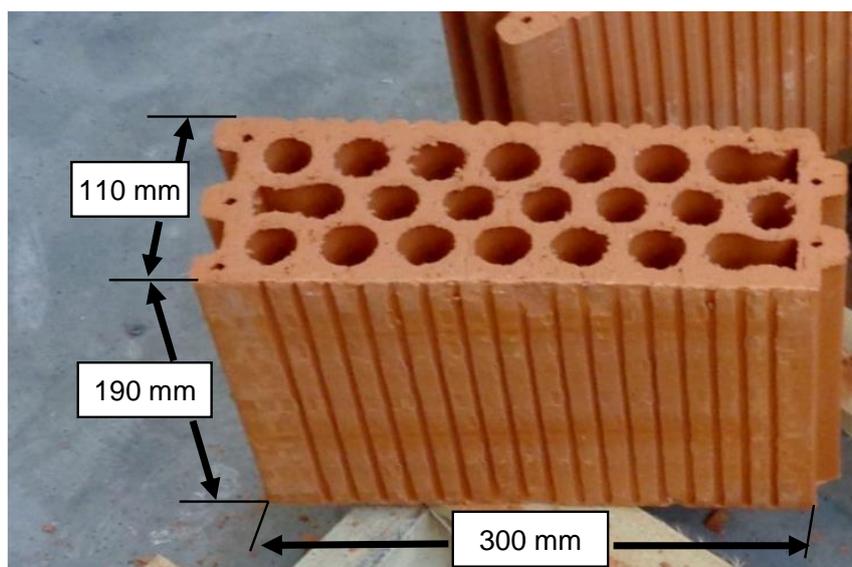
Aspecto y dimensiones de la pieza cerámica “Termoperforado de 10”
